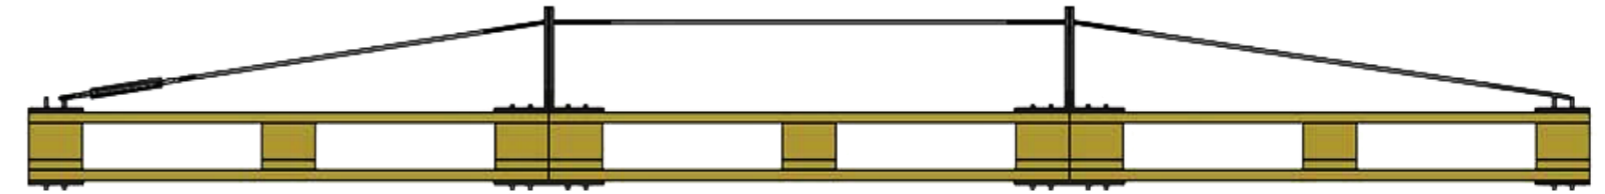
Paneles, cables y transparencia [2010] Fuente: Arquitectura Panamericana
